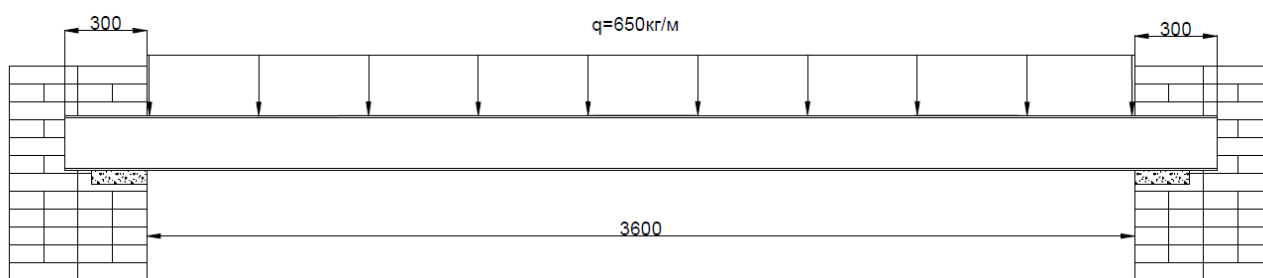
Балка двутаврового сечения в перекрытии с воздействующей на нее нагрузкой
